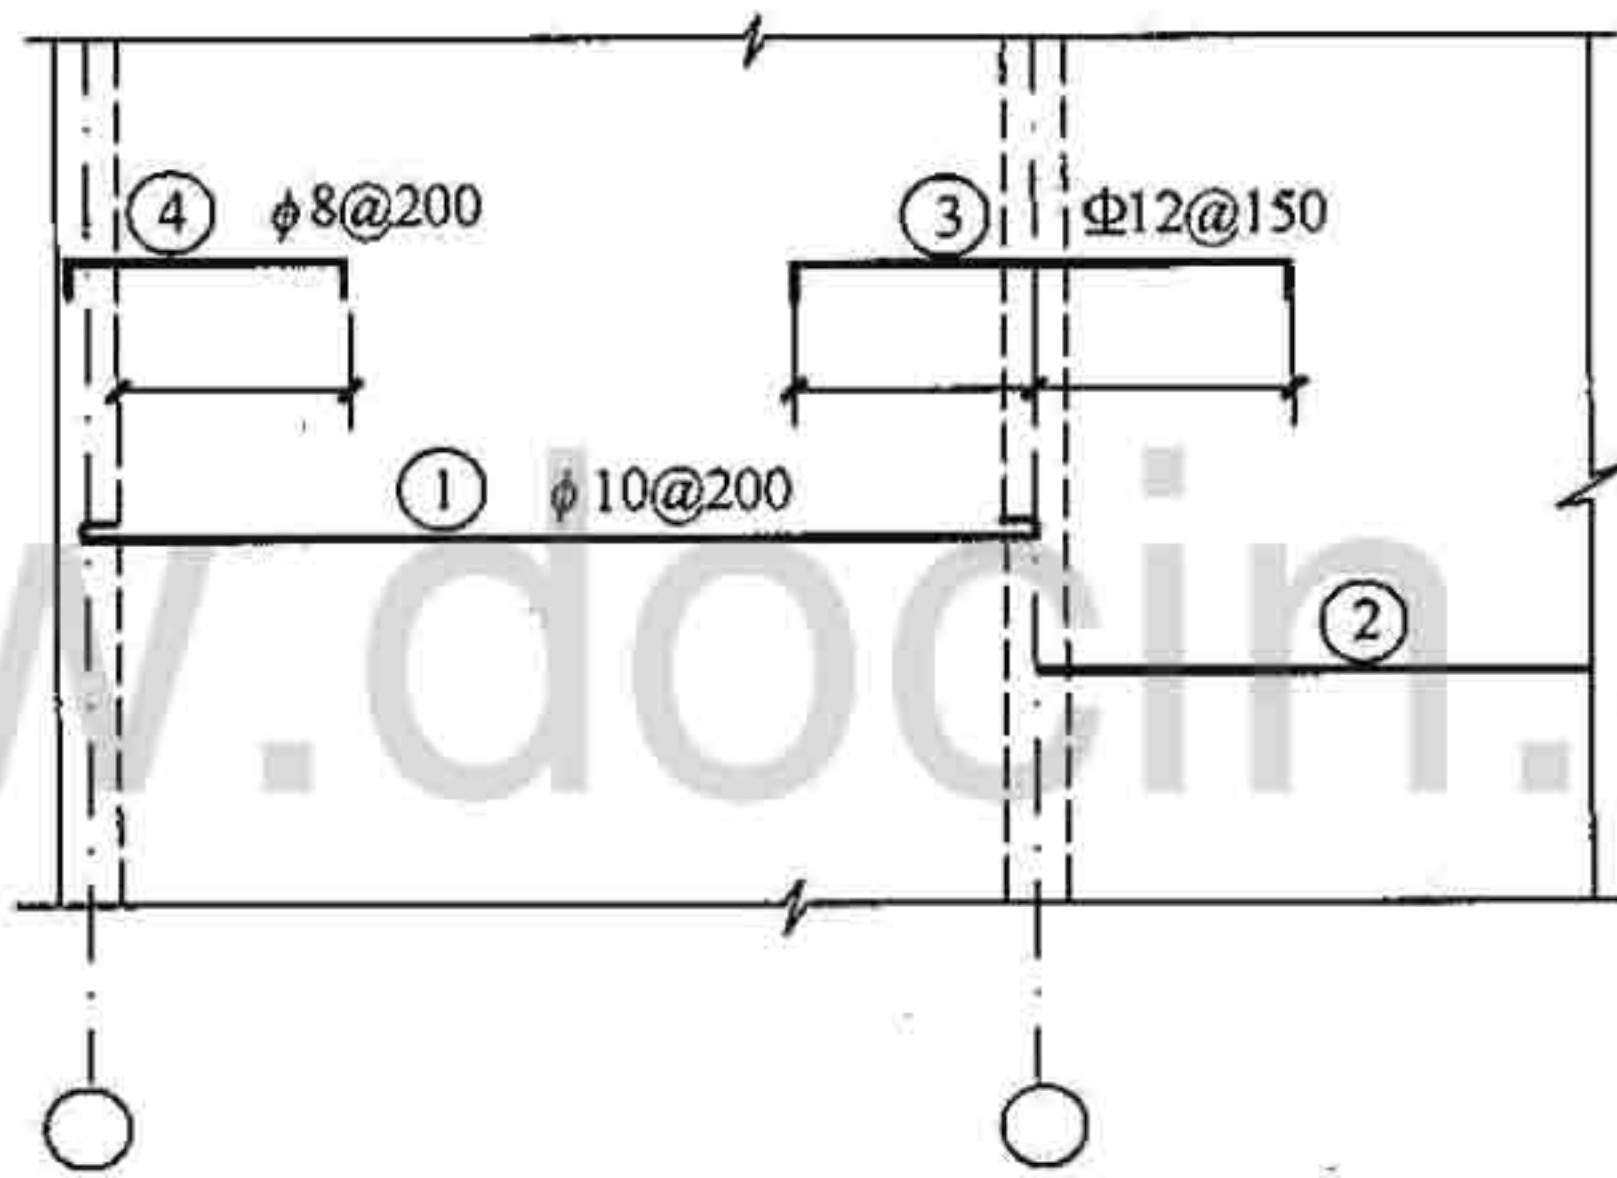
钢筋在楼板配筋图中的表示方法
